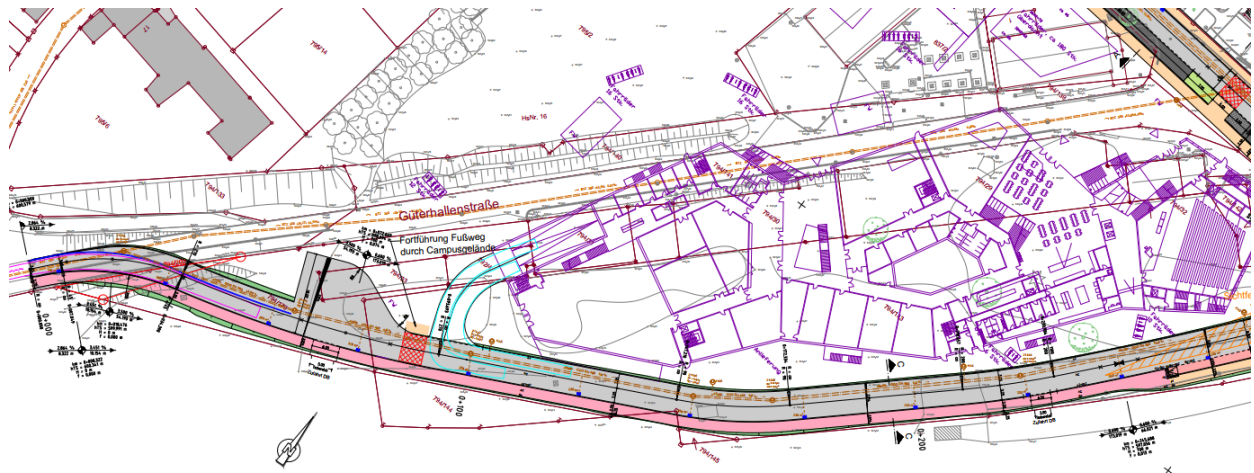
Lageplan Straßenplanung Güterhallenstraße, Stand 05.06.2023, Ingenieurbüro BPR, Traunstein
